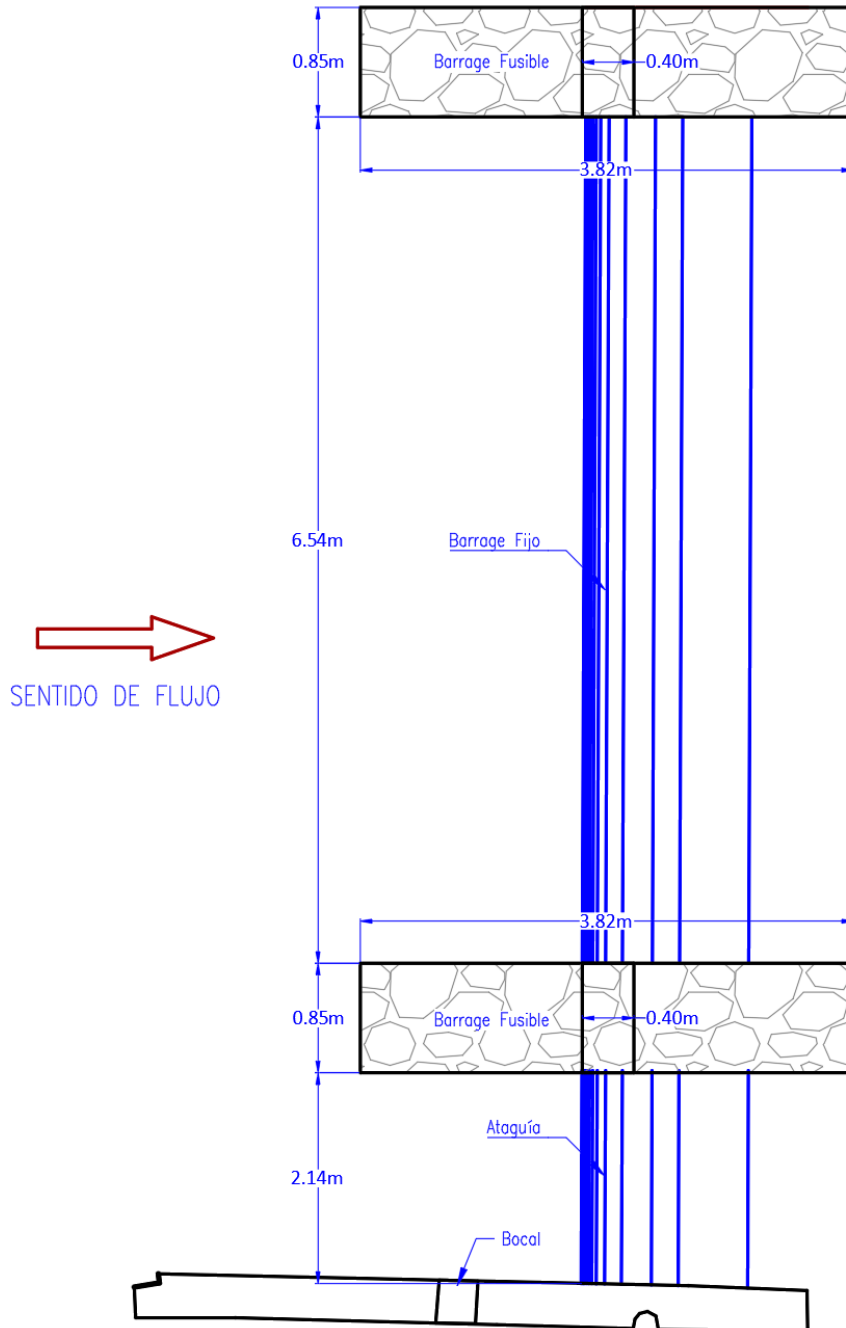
Vista en Planta del barrage fijo-fusible propuesto – Captación Río Porcón.
